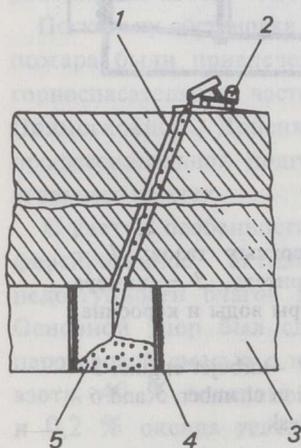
Схема возведения изолирующей перемычки: 1 — скважина, 2 — бетоновоз, 3 — горная выработка, 4 — опалубка перемычки, 5 — изоляционный материал (бетон)
